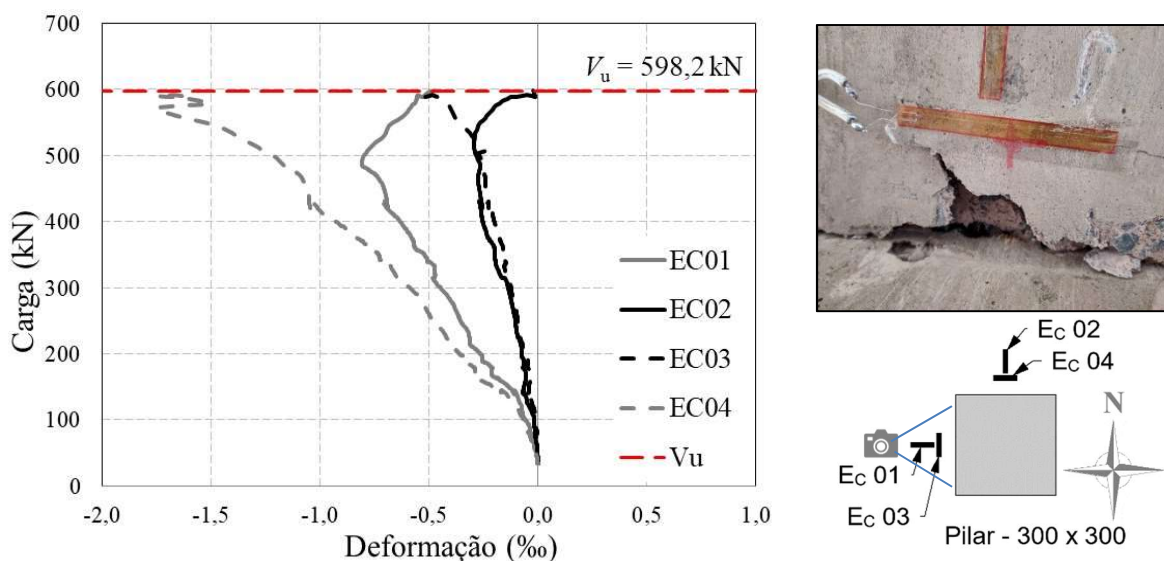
Deformações da superfície de concreto da laje CCA
